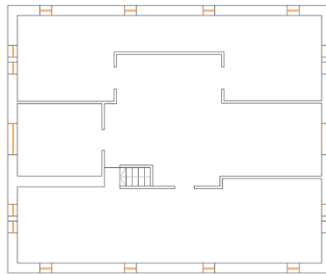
Plano de distribución Planta Bajo Cubierta. Fuente: CAD propio
